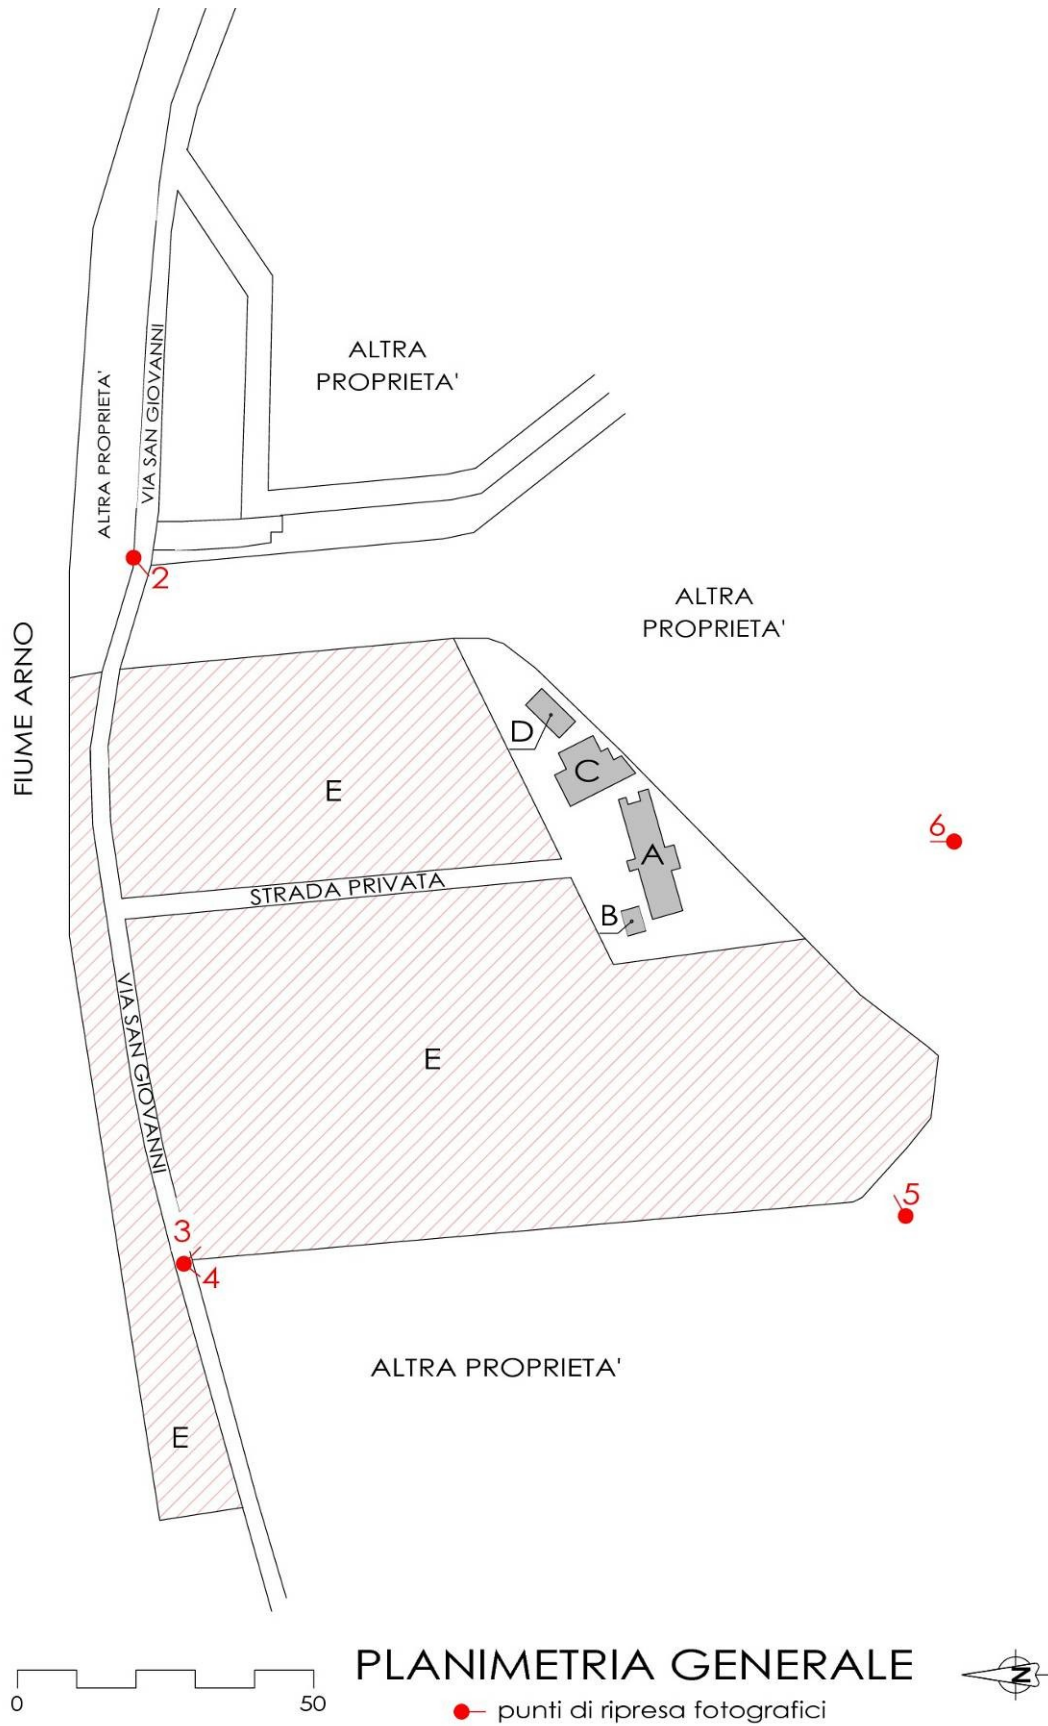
Punti di ripresa fotografici – Planimetria generale della proprietà
